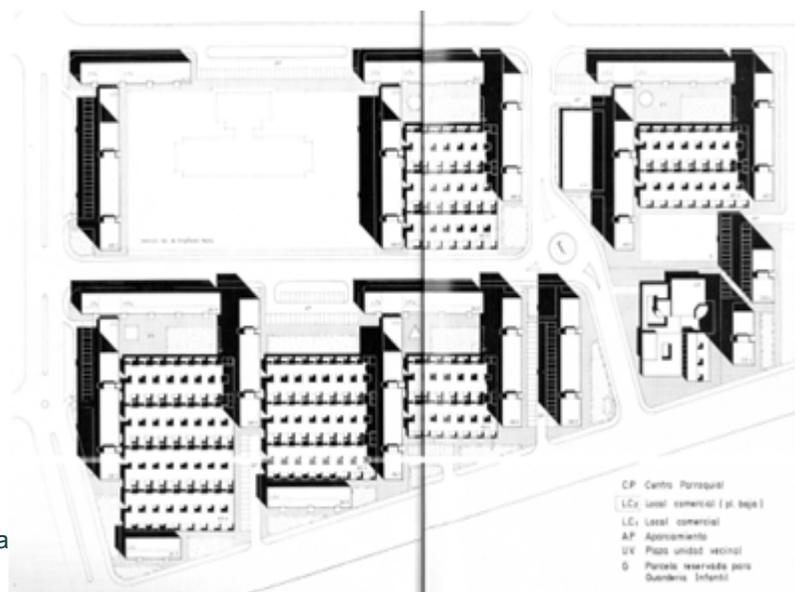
Grupo Antonio Rueda, planta del conjunto. Hogar y Arquitectura, 106.
